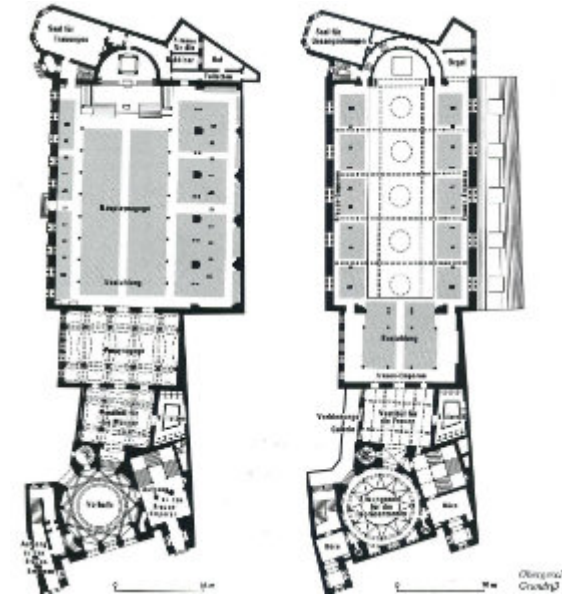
Grundriss Synagoge Berlin
